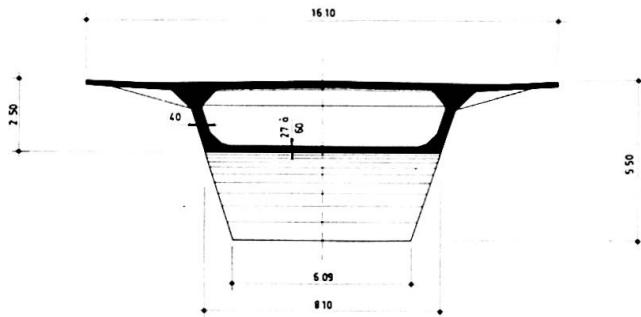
Sections transversales des ponts d'OTTMARSHEIM et de GENNEVILLIERS
